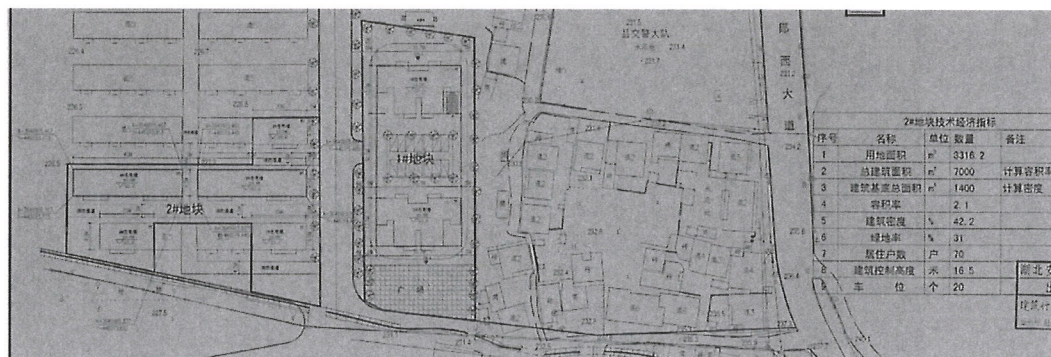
佘家湾 2#地块安置房总平面布置图及技术经济指标
